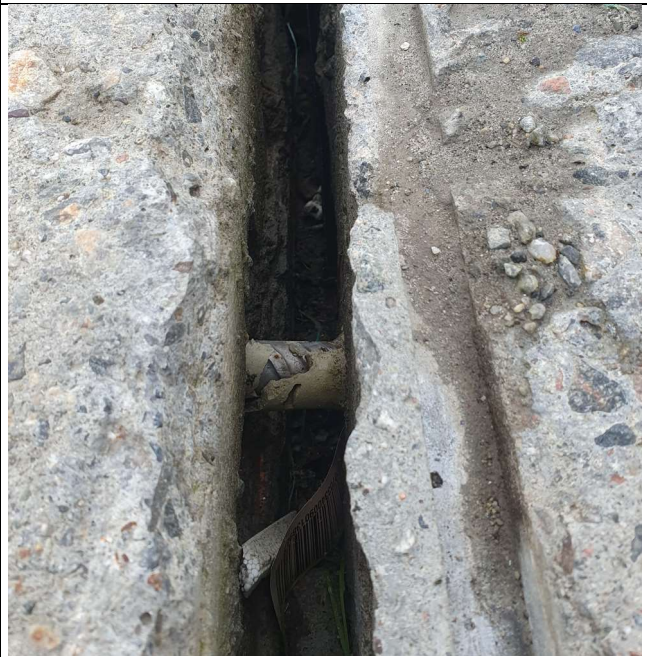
Innboret armering dratt ut av betongen i kaidekket. Bilde fra ca. akse 13, målepunkt 8.
